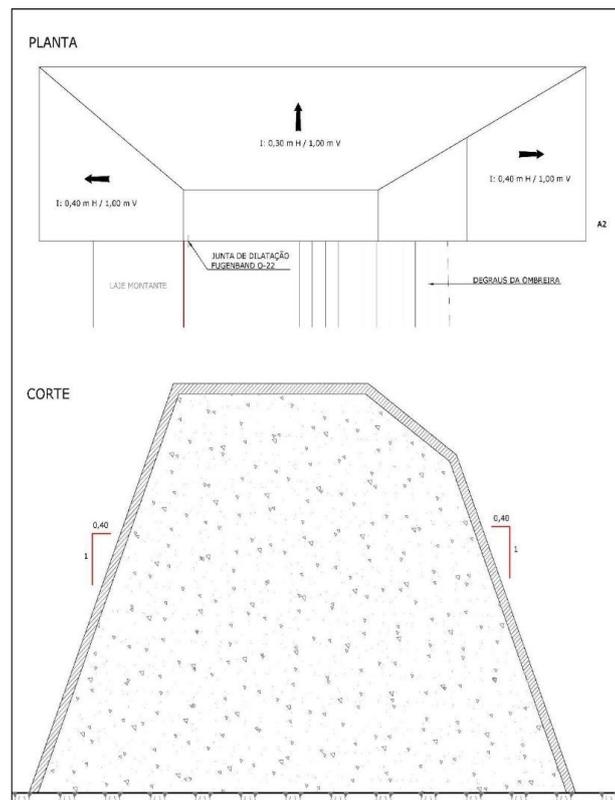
Muro de Transição da Ombreira Esquerda – Planta e Perfil. Fonte: Enebrás
